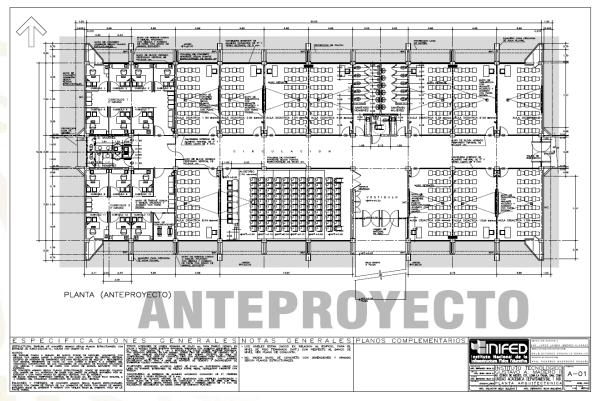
Anteproyecto. Planta arquitectónica, Edificio de Un Nivel. ITGAMII
